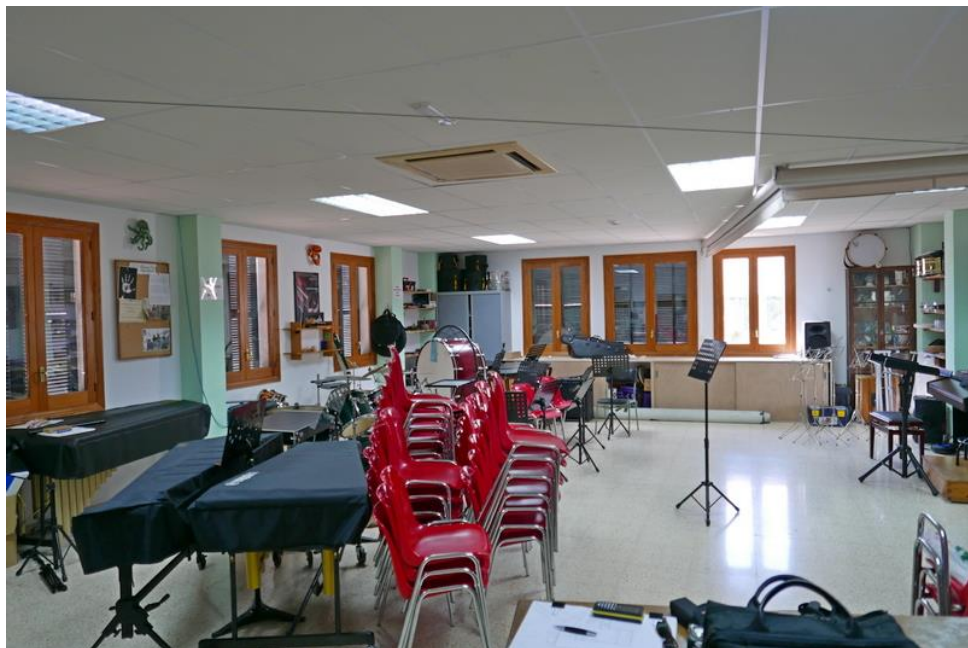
Vista de la zona donde se ubicarán las rampas de acceso a la planta baja
